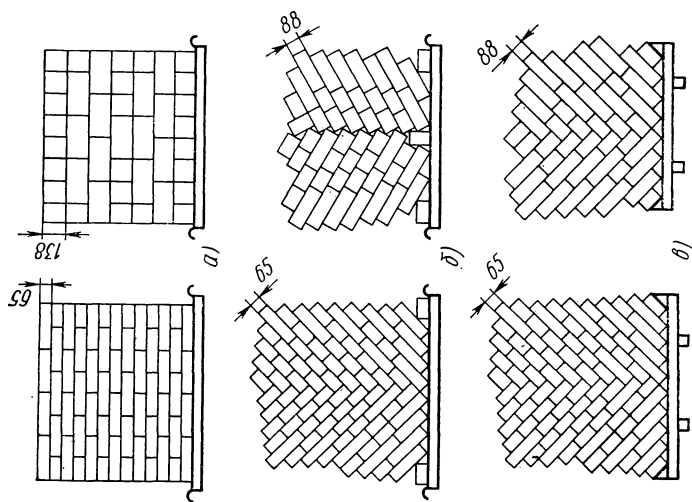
Схемы укладки кирпича и керамических камней на поддоны:
